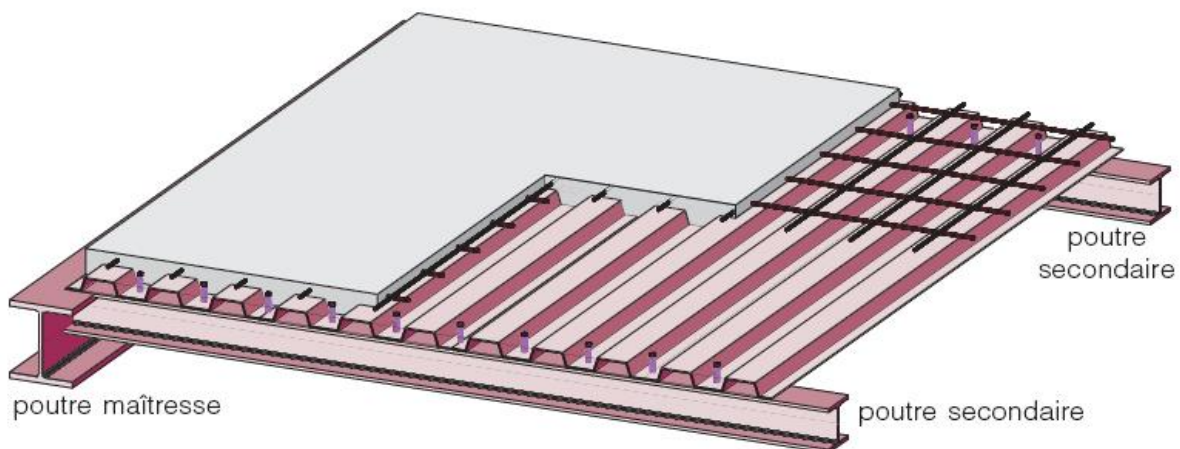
Vue d'une structure mixte acier-béton avec dalle mixte
